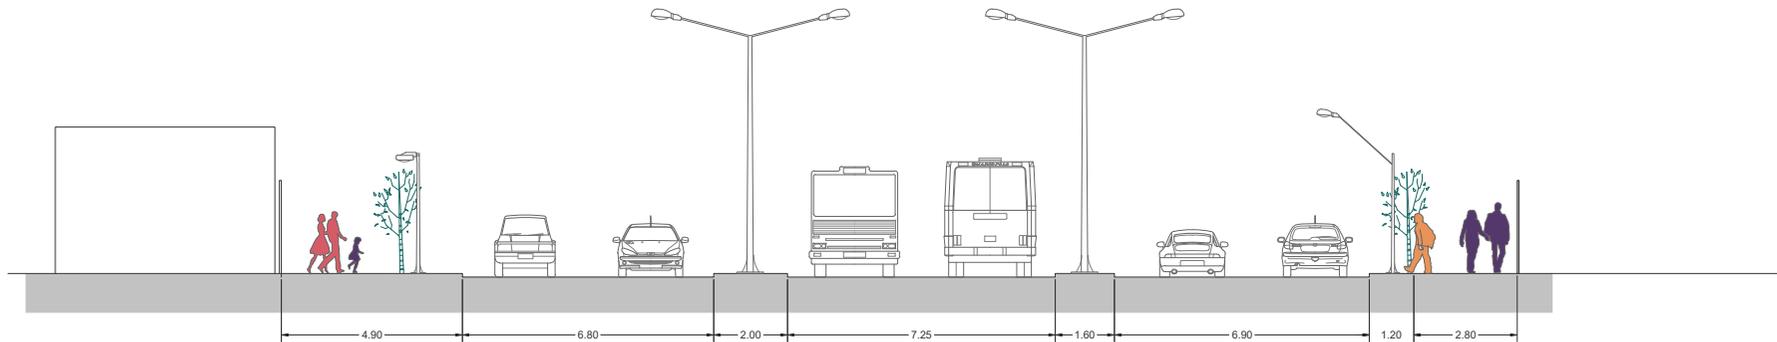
Perfil vial esquemático de calle María Rozas Velázquez.
